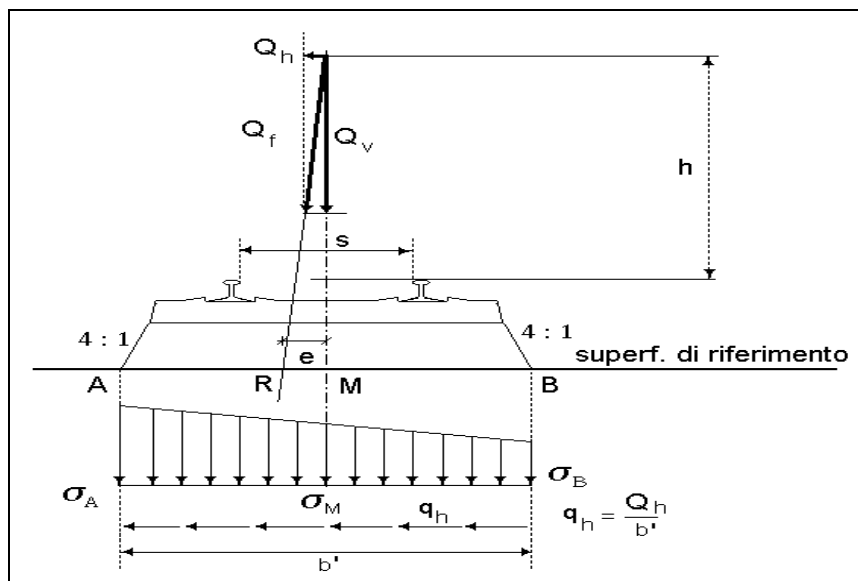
Distribuzione trasversale in rettilineo delle azioni per mezzo delle traverse e del ballast
